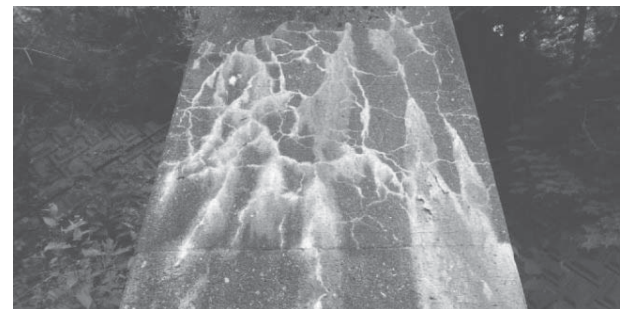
アルカリ骨材反応の可能性のあるひび割れ
